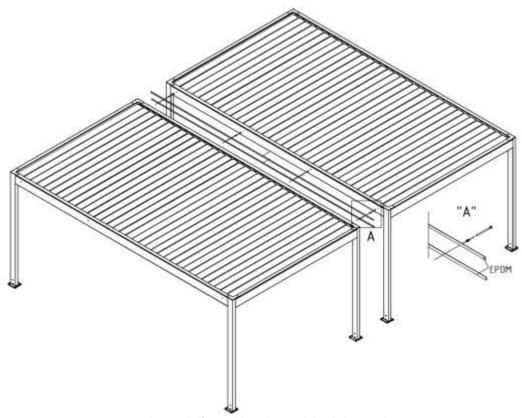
Vue de l'assemblage des modules de la Pergola
